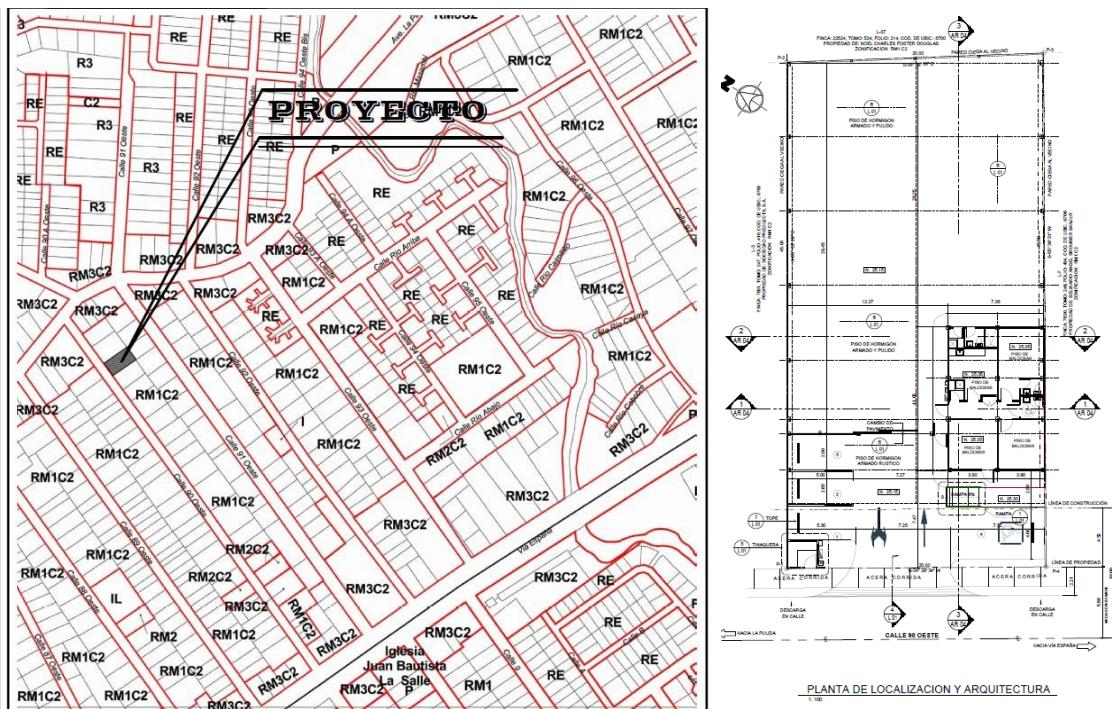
Ubicación del proyecto en el corregimiento de Río Abajo y planta arquitectónica.
